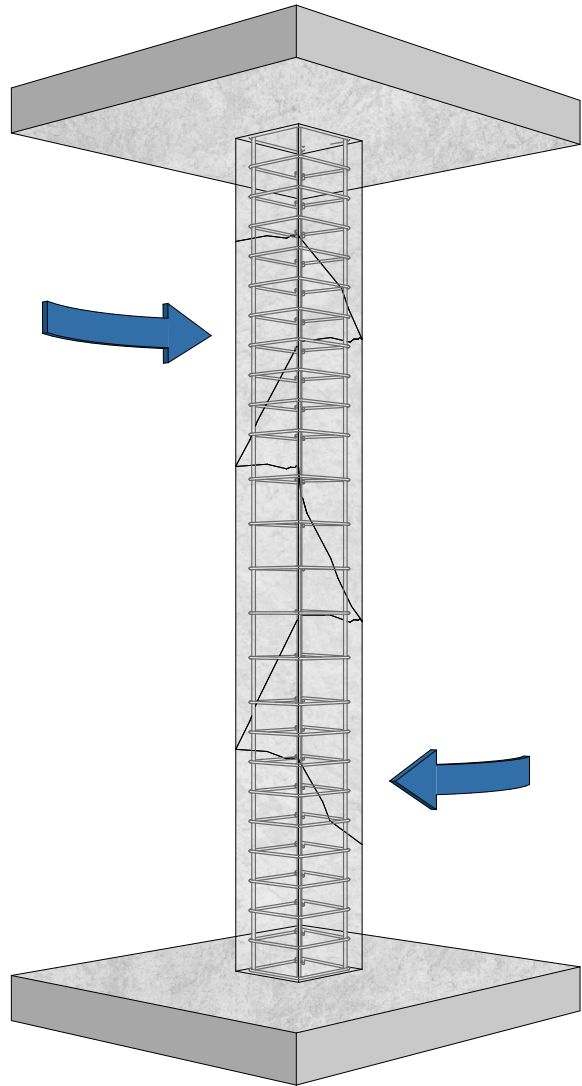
Fisuración por torsión en columna de hormigón armado. (Autores, 2017)
